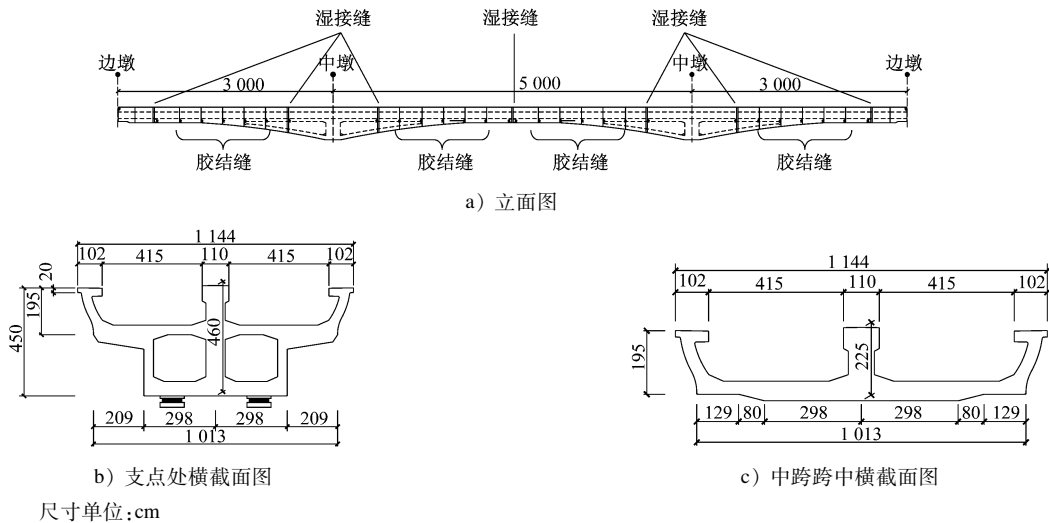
17 号线双 U 型-箱型连续梁典型立面图和横截面图
